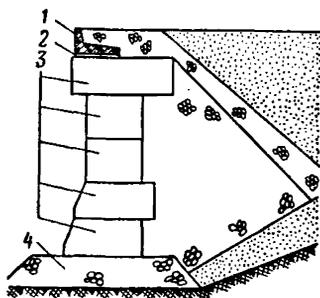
Поперечный разрез набережной из правильной массивной кладки
